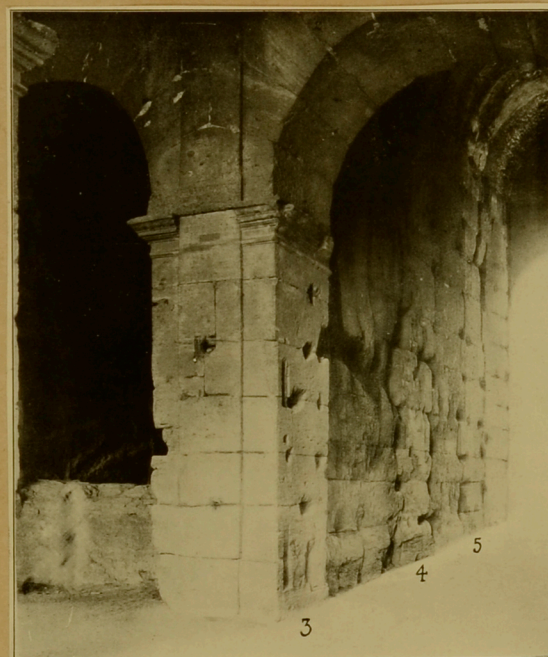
PILASTRI E RIEMPIMENTI IN UNO DEI MURI RADIALI A PIANTERRENO.
